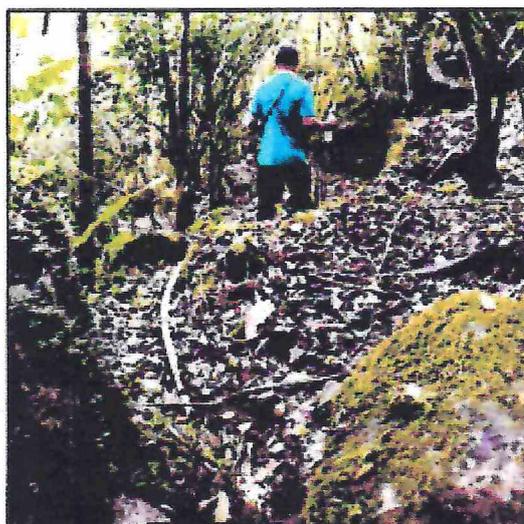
, Se aprecia tramo de línea de conducción, con el diámetro modificado, debido a la falta de presupuesto de parte de la JASS
